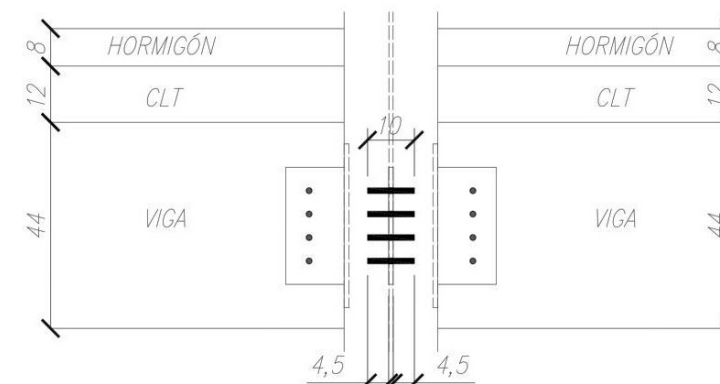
Detalle unión pilar metálico y viga GLT (Glulam)
